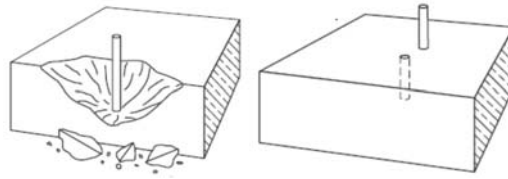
Mënyrat e shkatërrimit nga prerja 1)shkatërrimi i skajit të betonit(concrete breakout); 2)shkatërrimi i çelikut (steel failure) [13].
